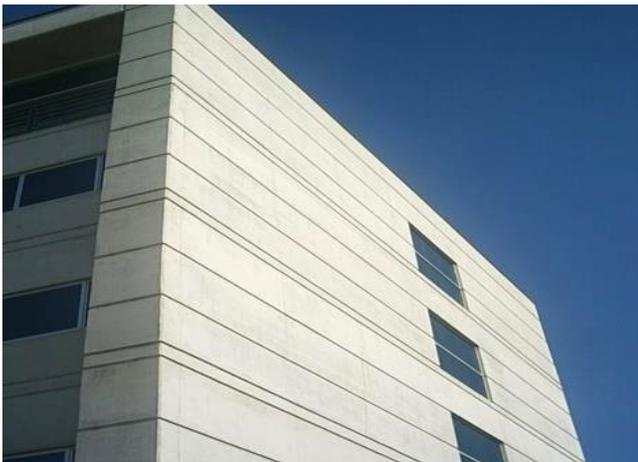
Vista del muro terminado fachada norte (Edificio Fac. de Medicina Universidad de La Frontera) (Autor)
